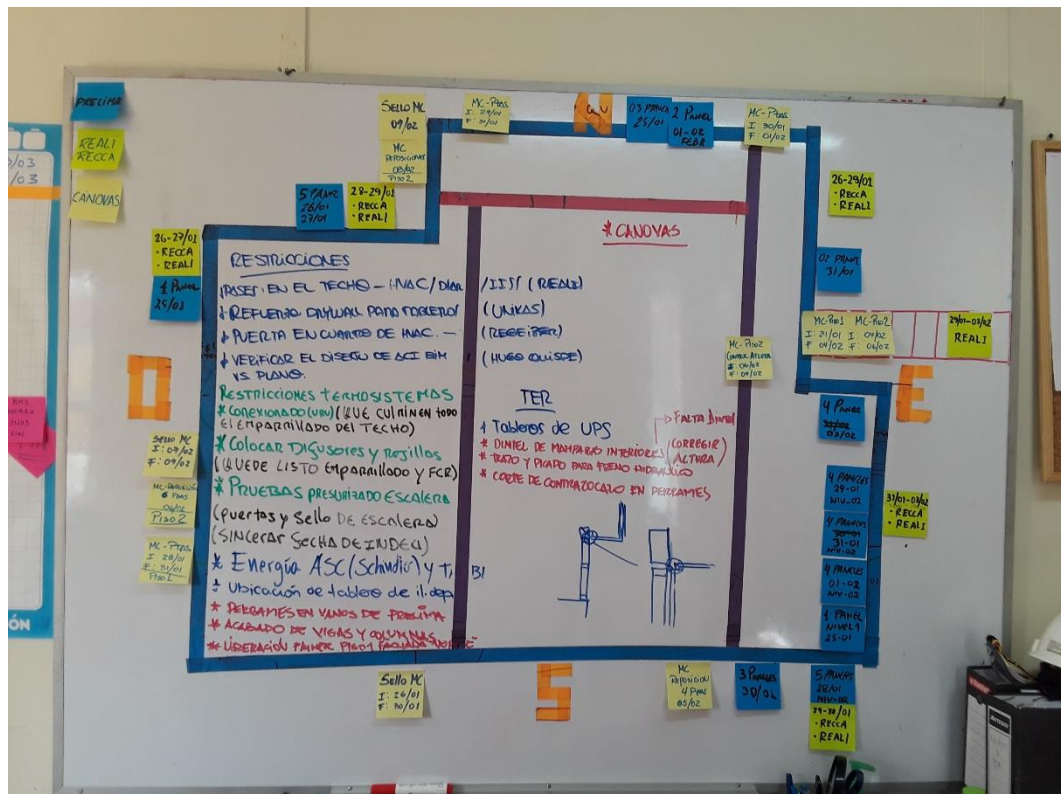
Planificación colaborativa de las actividades en fachada. Fuente: Archivos del autor.
